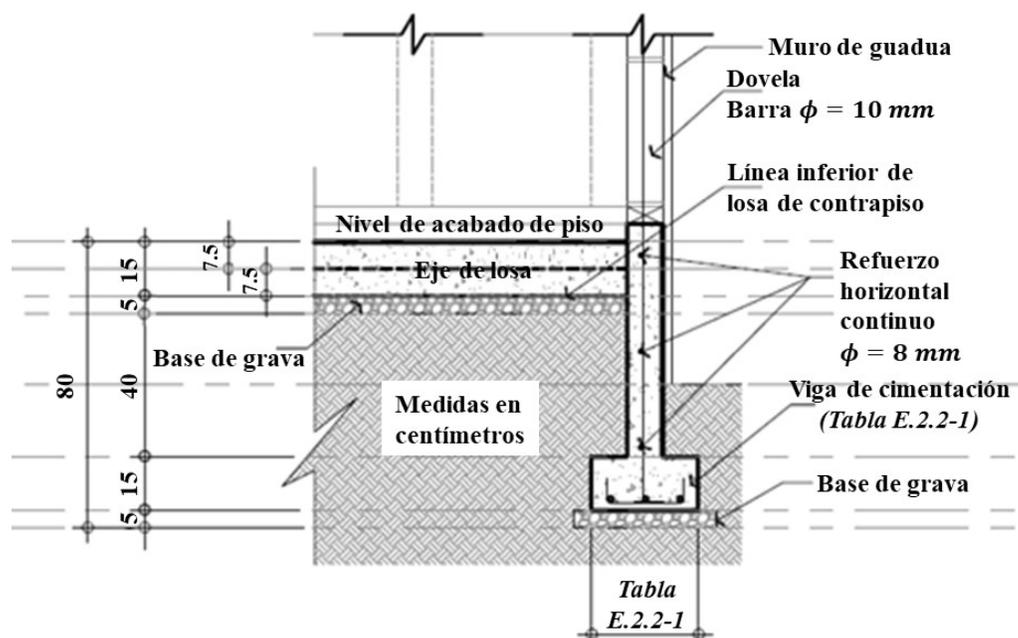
Detalle de dovela de anclaje para muro de bahareque, (www.basebuilds.com)
